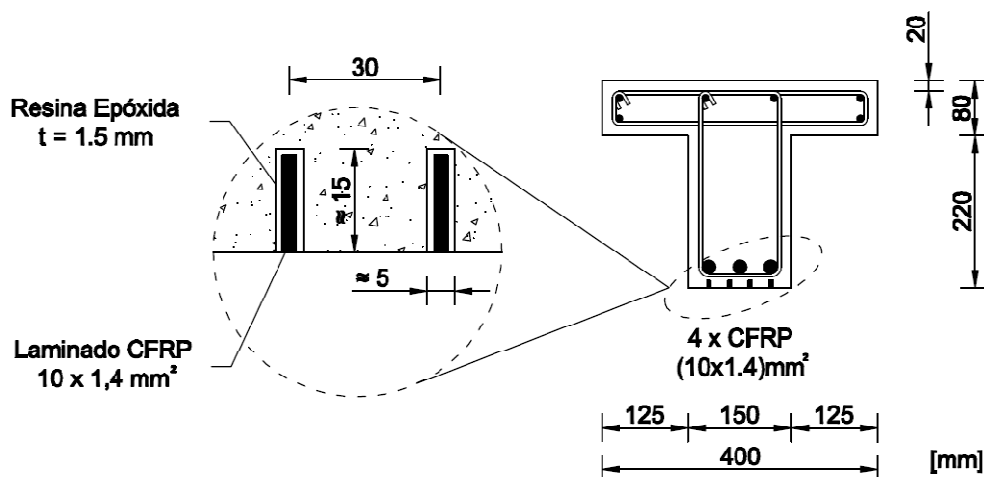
Pormenorização transversal do sistema de reforço testado nos modelos TSC4 e TSC5
